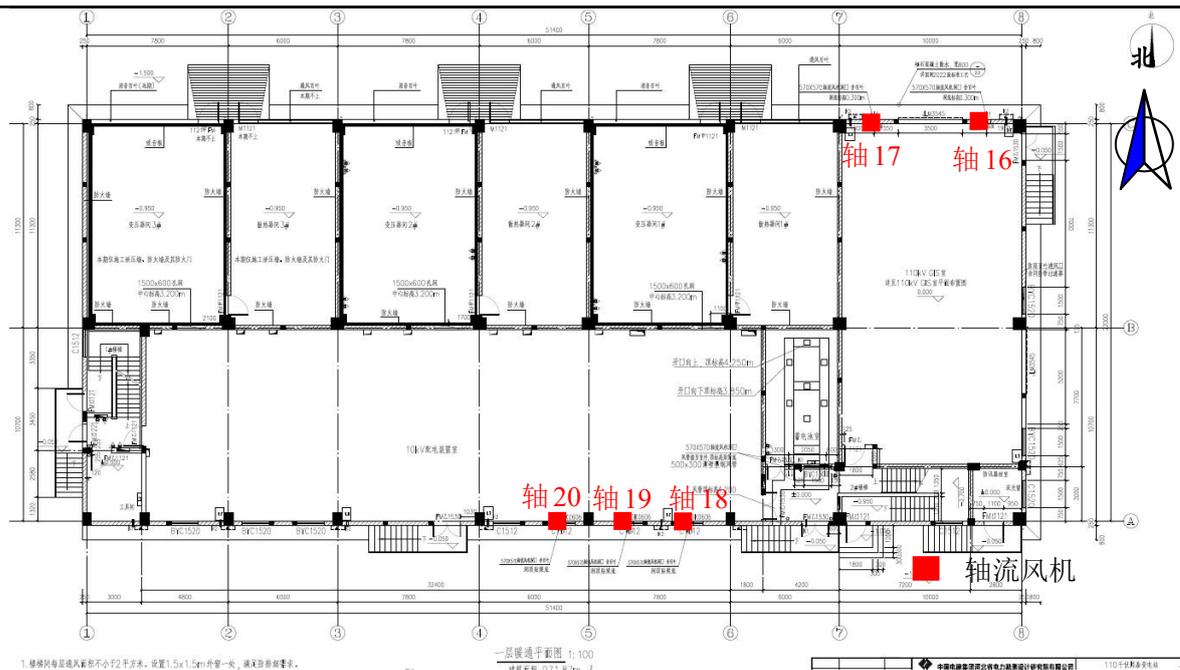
110kV 熙泰变电站声源分布情况示意图（一层平面图）
